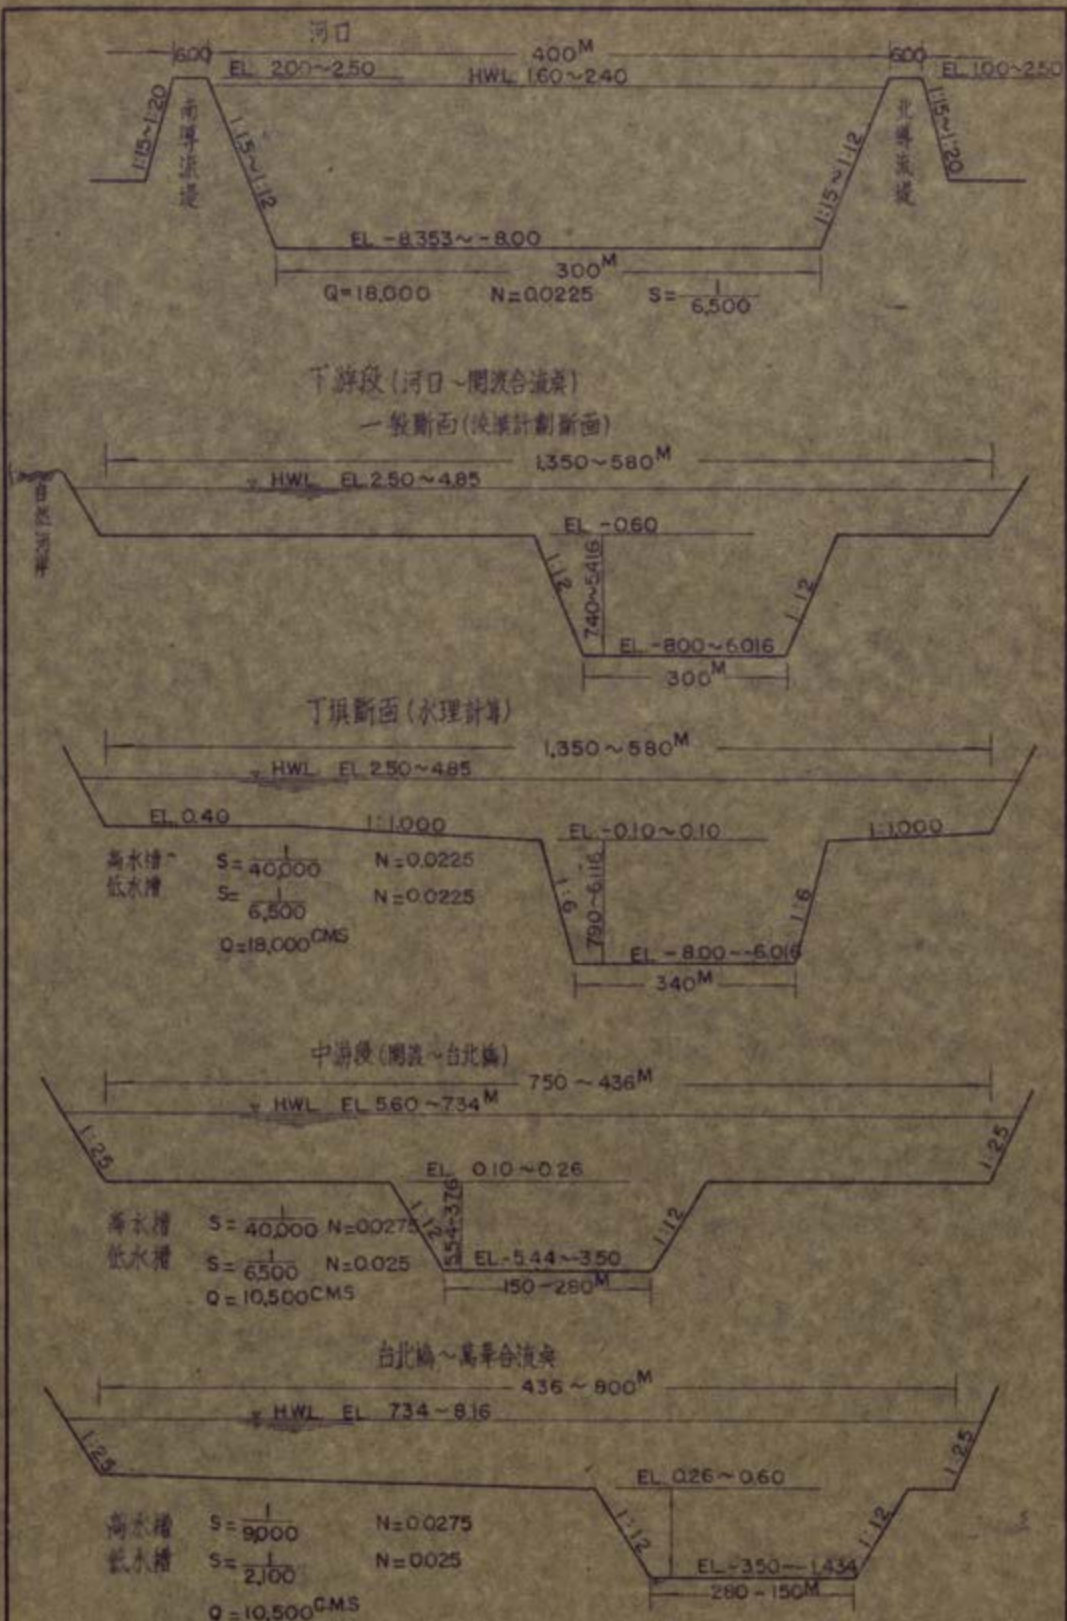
淡水河計劃河槽断面圖 (第四案)
